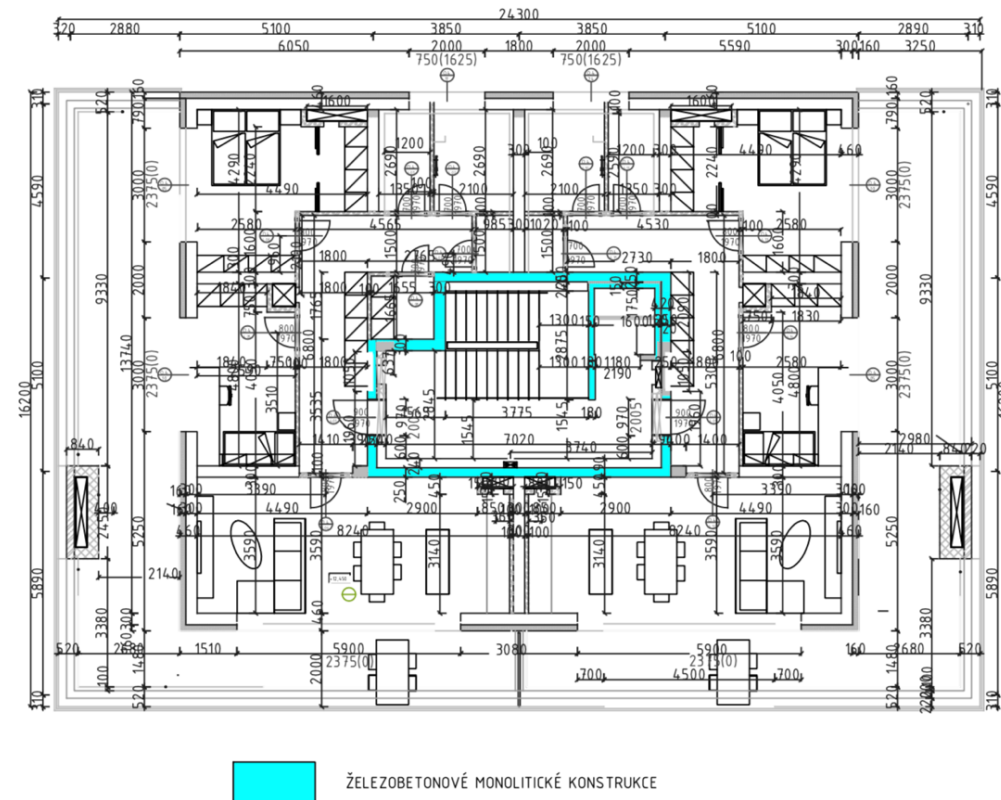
Železobetonové monolitické konstrukce, 2.NP
